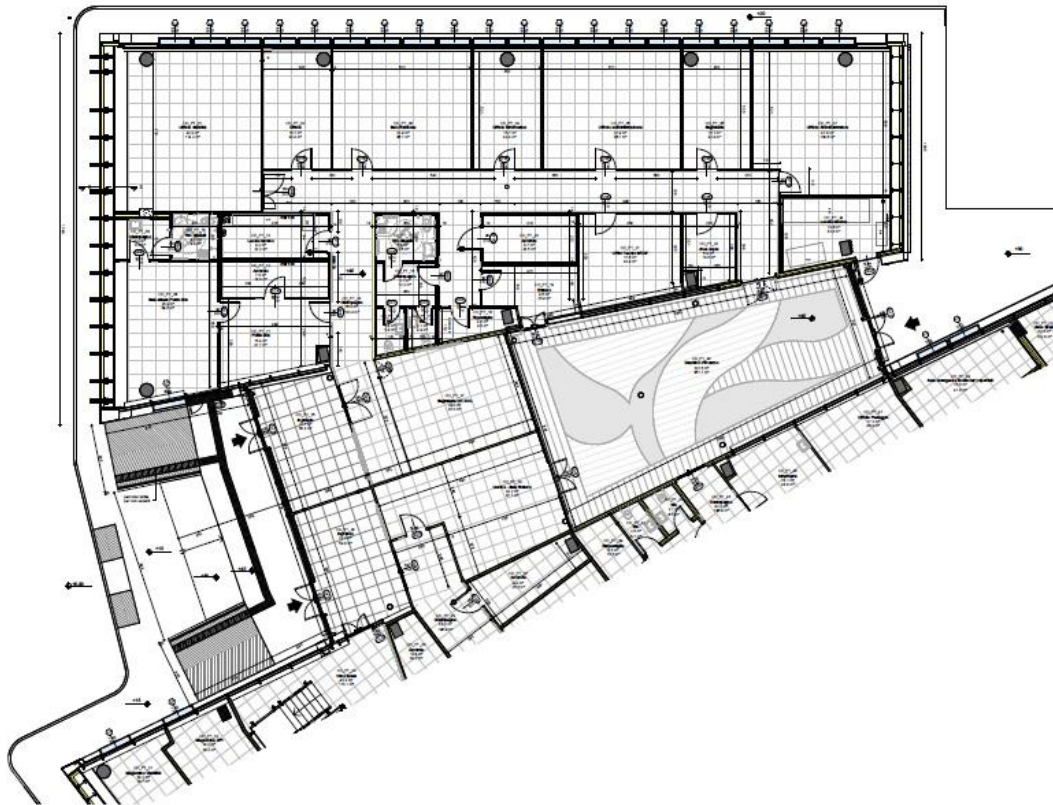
Vista planimetrica (piano terreno) del complesso immobiliare in progetto
